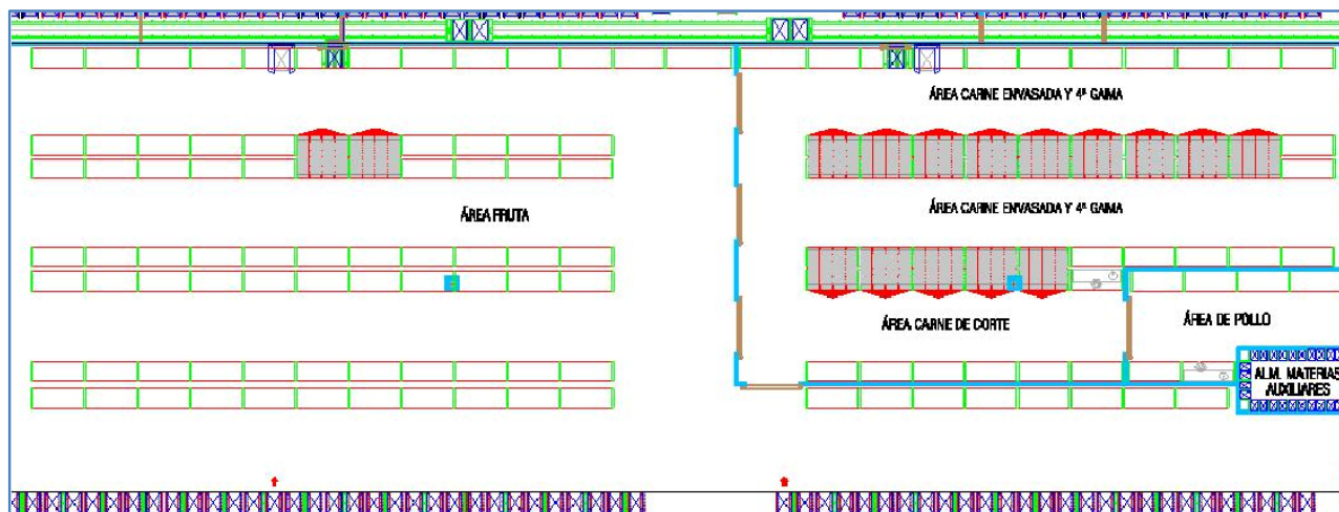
Detalle área estantería paletización escenario convencional Fuente Elaboración propia
